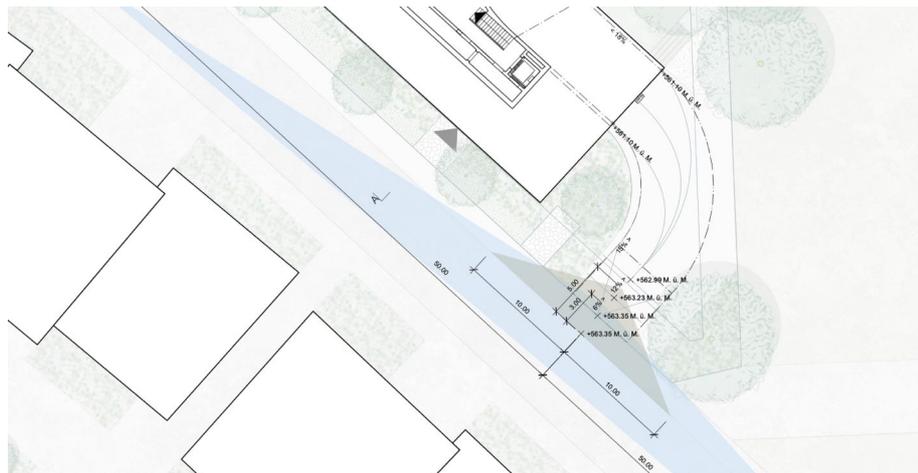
Zufahrtsbereich zur Einstellhalle
